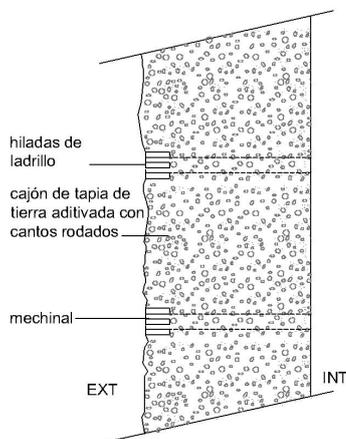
Esquema de sección del muro Sur de la iglesia de San Boal en Pozaldez. AV.
